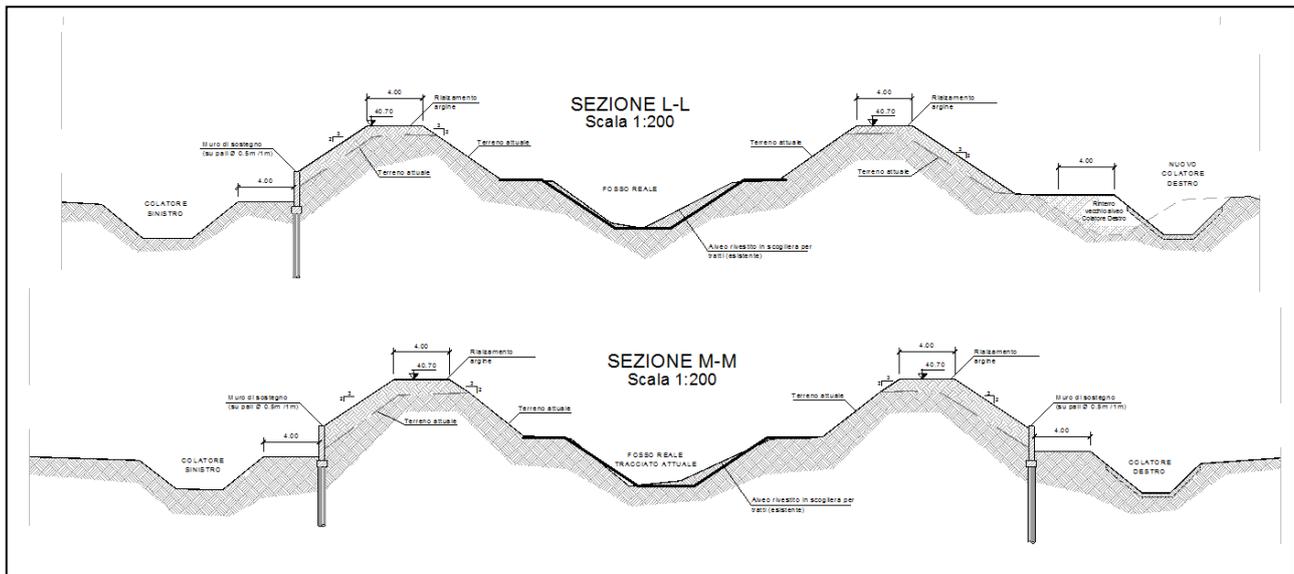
Sezione di progetto Canale Scolmatore tratto esistente da adeguare
